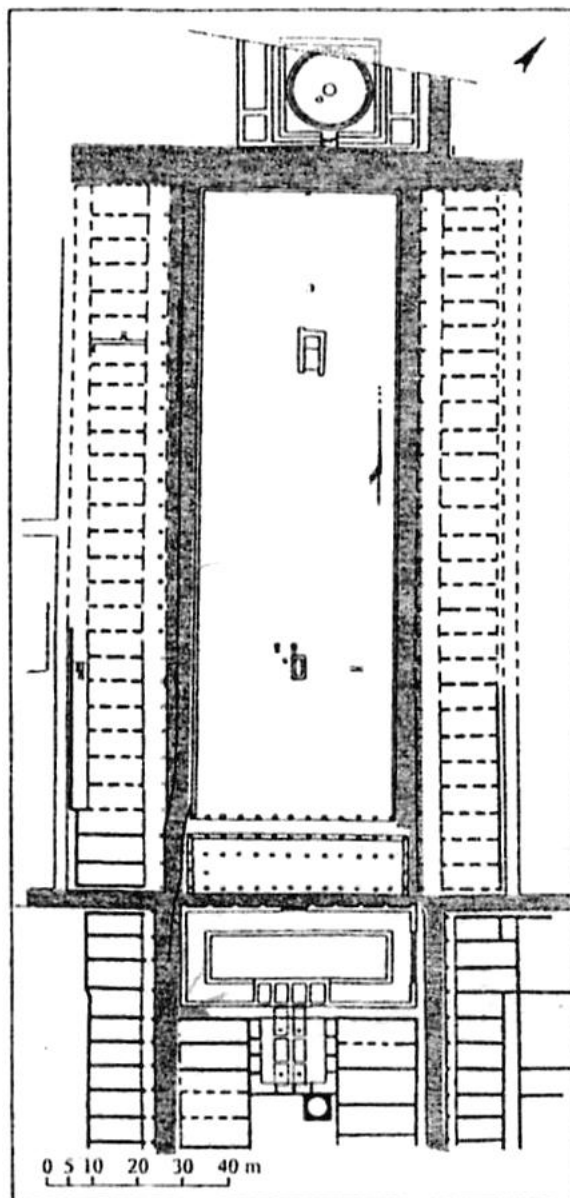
Planimetria generale (da A. Etxebarria Akaiturri).
